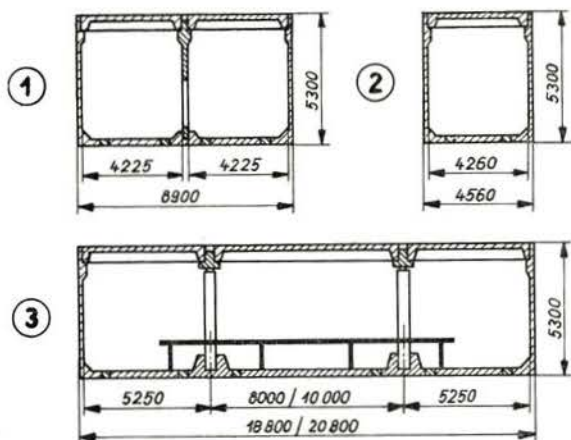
Bei neuen Streckenabschnitten wird auch die Bauausführung mit Stahlbetonfertigteilen angewendet. 1. Streckentunnel, zweigleisig, 2. Streckentunnel, eingleisig, 3. Stationsquerschnitt
